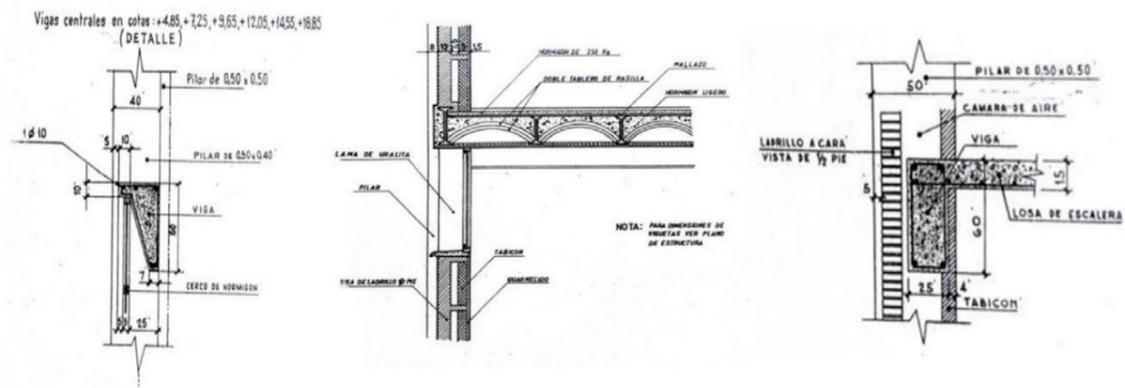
Detalles constructivos de la fábrica Gal. De izquierda a derecha, encuentro de viga con pilar y hueco de fachada; detalle de encuentro del forjado unidireccional de viguetas con el cerramiento y detalle de encuentro de losa de escalera con fachada
